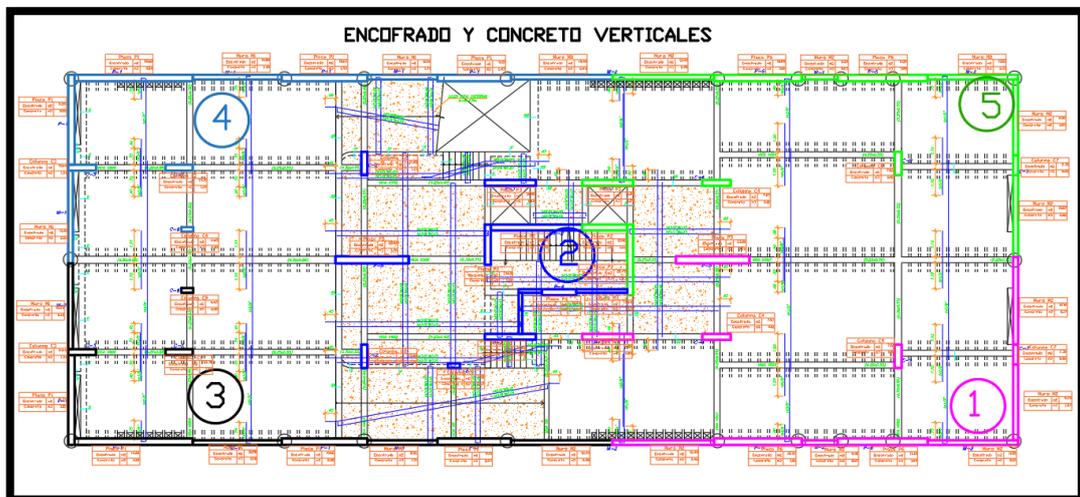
Sectorización de Elementos verticales para encofrado y vaciado de Concreto – Sótano 1.
